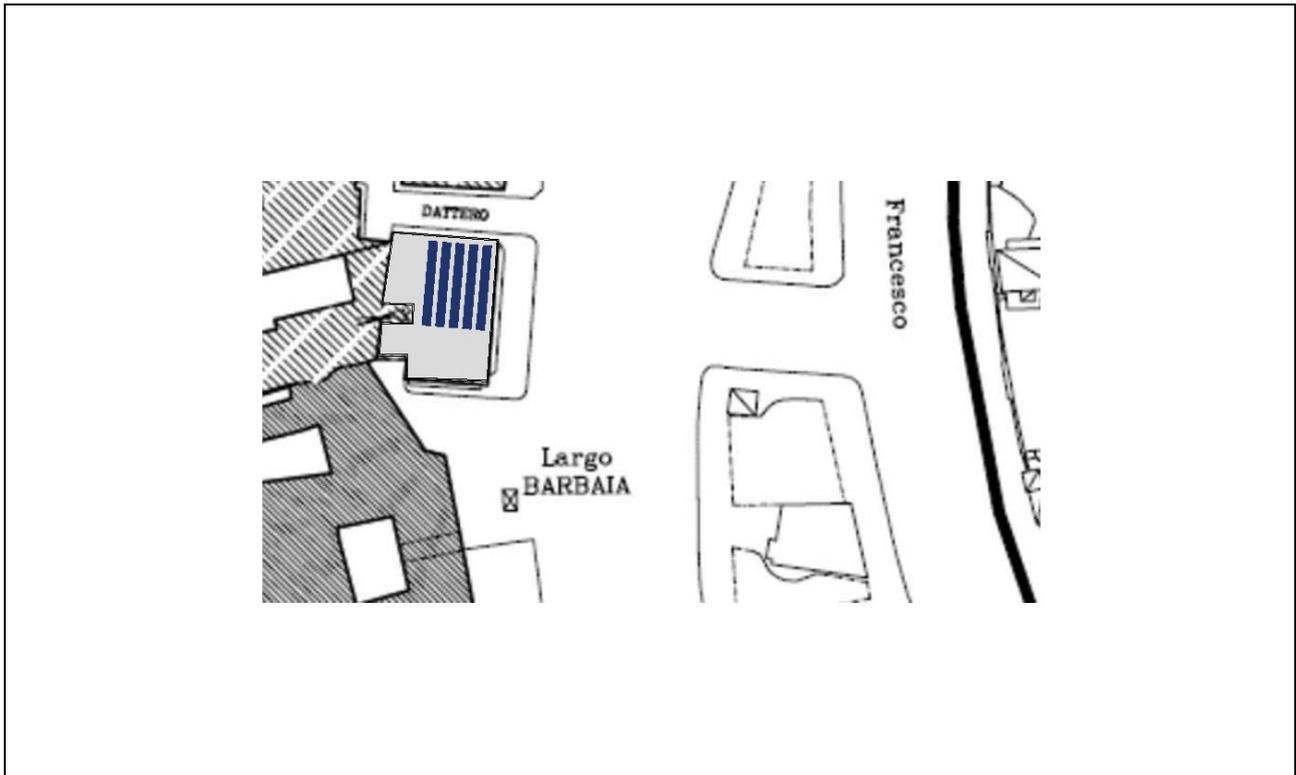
Planimetria impianto fotovoltaico stazione funicolare di Mergellina
